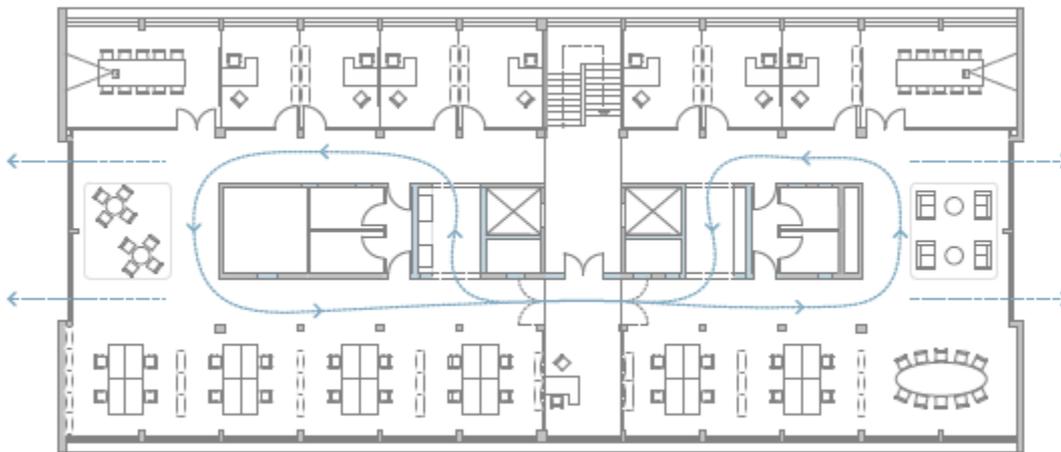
Grundriss Umbau Herdentorsteinweg 7 - Nutzungseinheiten
